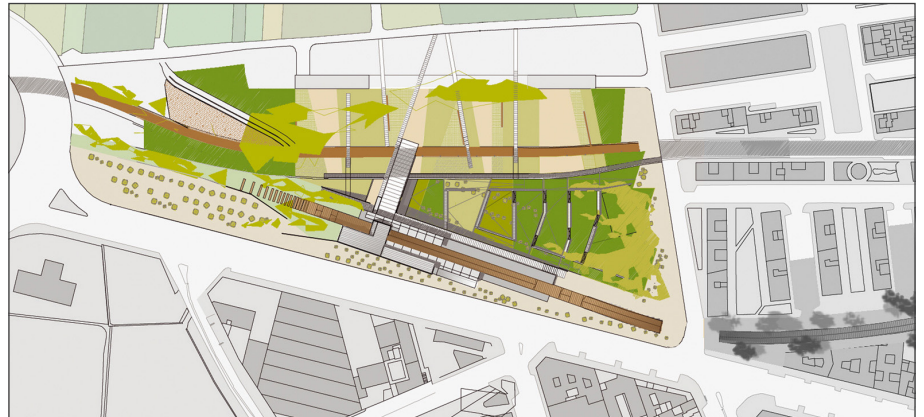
Planta Estación Alboraya-Palmaret. Rstudio/Wikiarquitectura.
